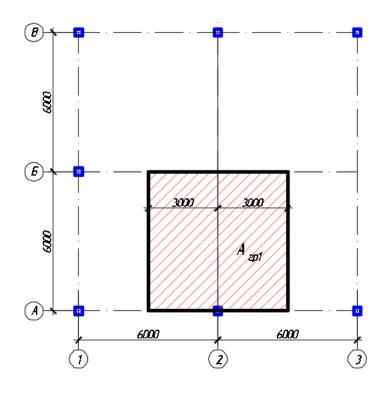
Грузовая площадь на фундамент в осях 2/А
